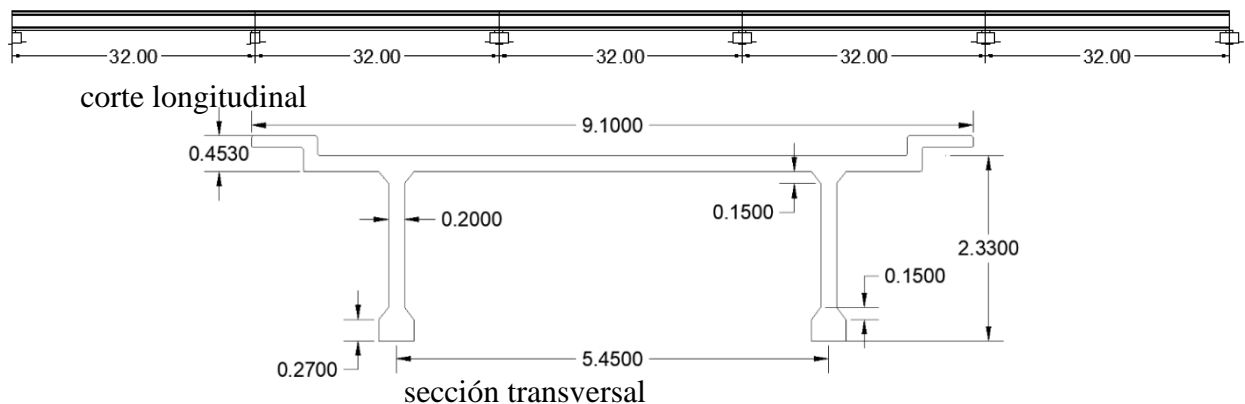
Geometría superestructura puente “El Gavilán” (Acot. m).
